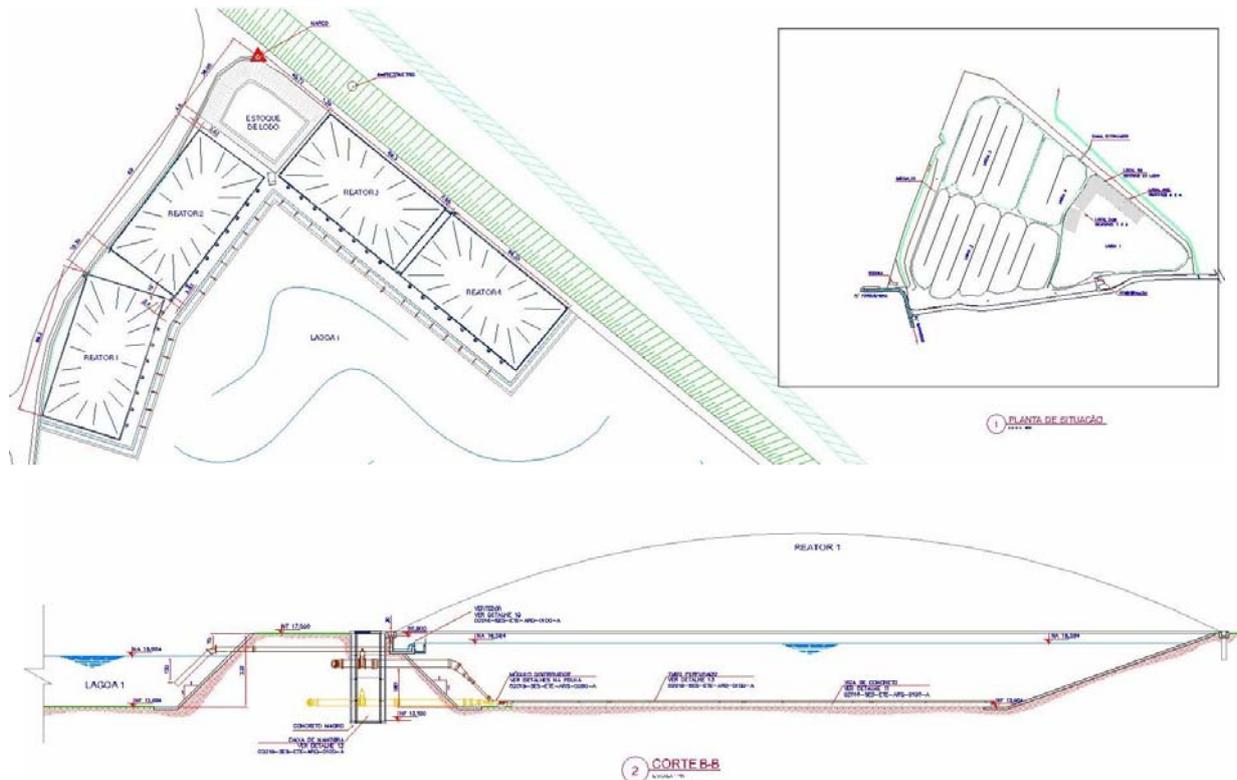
Planta baixa e corte do reator anaeróbio construído em terra dentro de uma lagoa anaeróbia.
